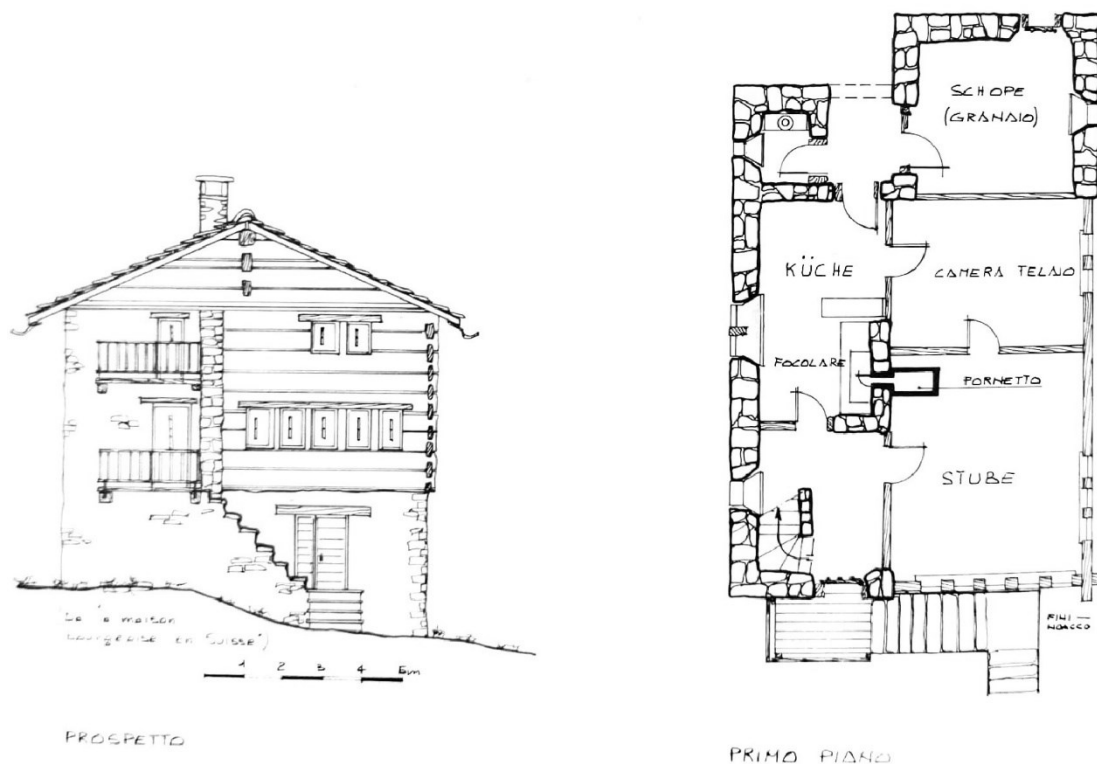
prospetto e pianta del primo piano di una casa nella frazione di Randa a Zermatt
